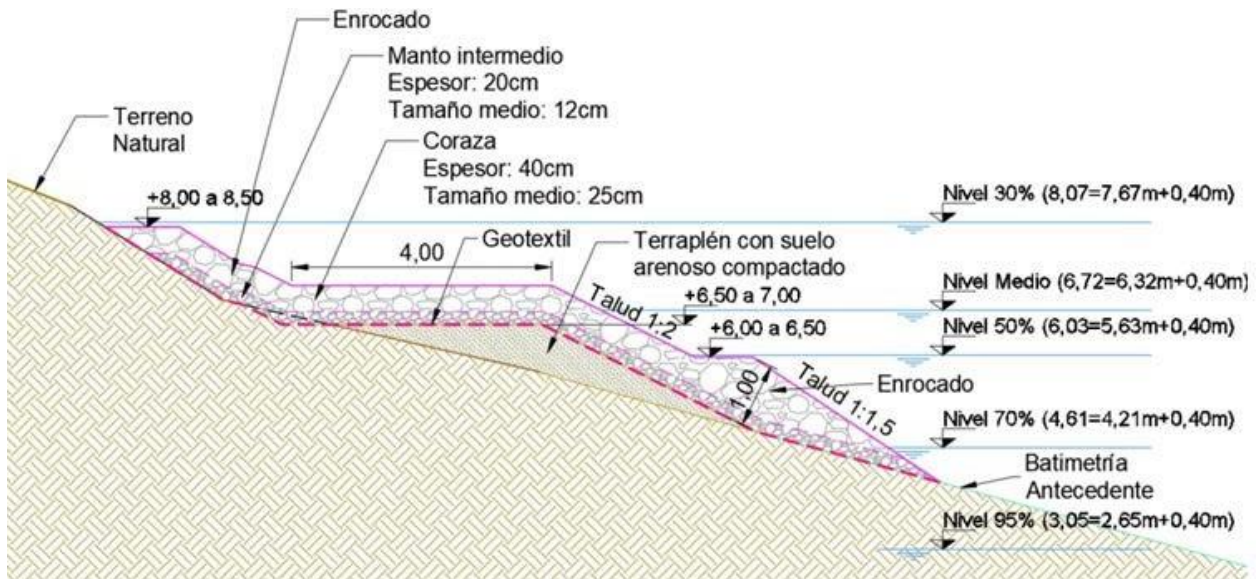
Alternativa de protección con enrocado del pie de la barranca
